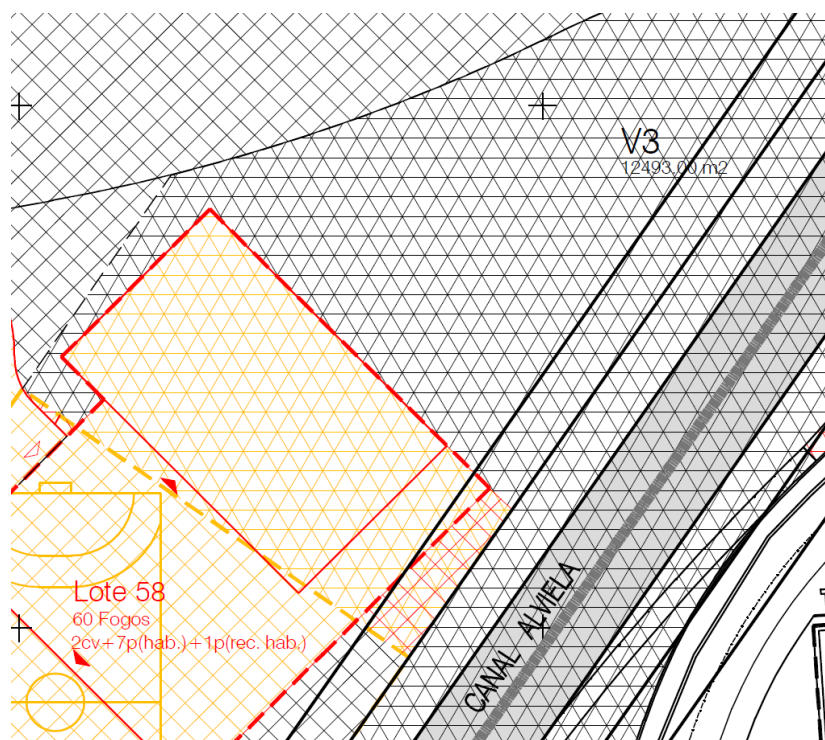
Planta de Síntese Proposta - Alterações*. Implantação do lote 58 sobre o espaço verde V3.
